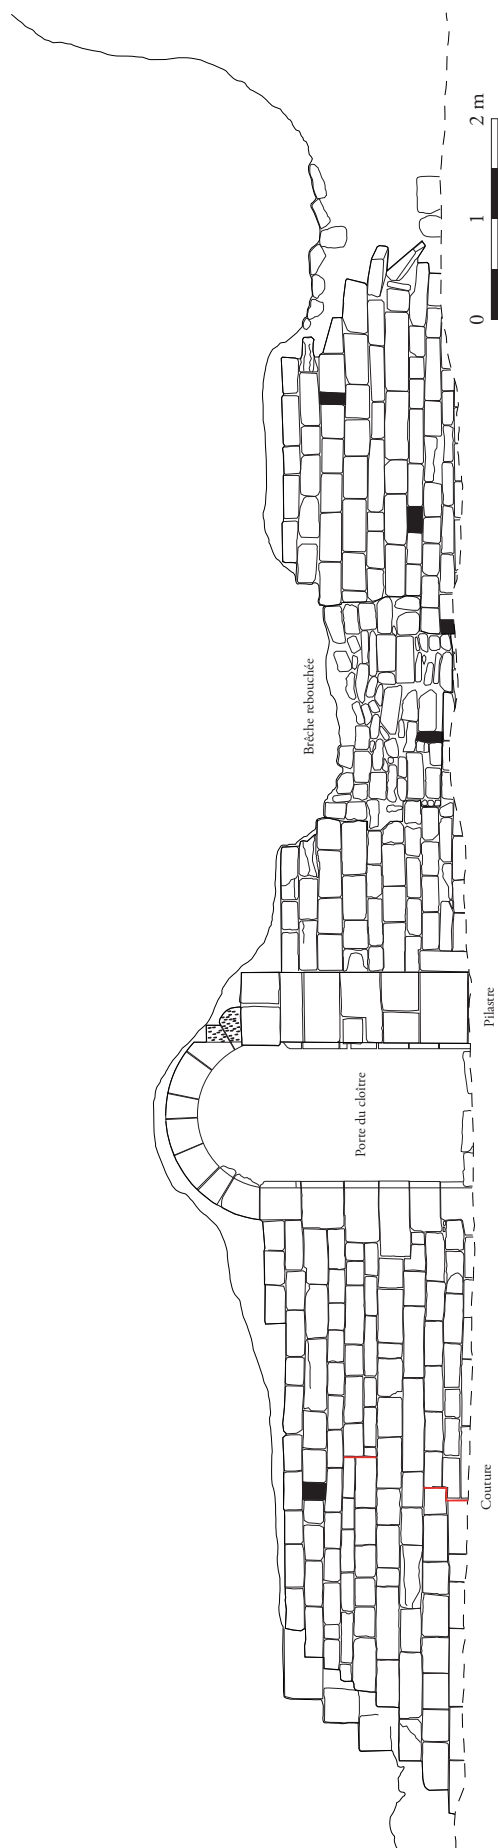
Abbaye de Haute-Seille. Parement intérieur du mur gouttereau sud (relevé Guillaume Huot-Marchand et coll. ; DAO Carine Antoine, Cédric Moulis). [A3]
